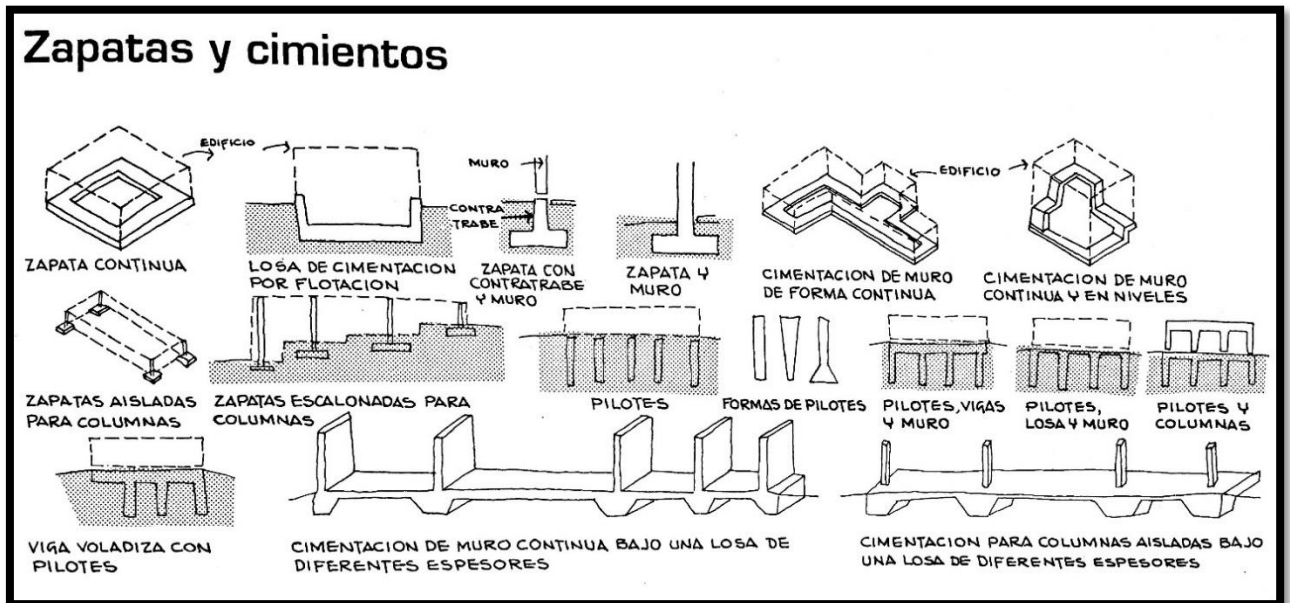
Representación de Tipos de Zapatas y Cimentaciones.
